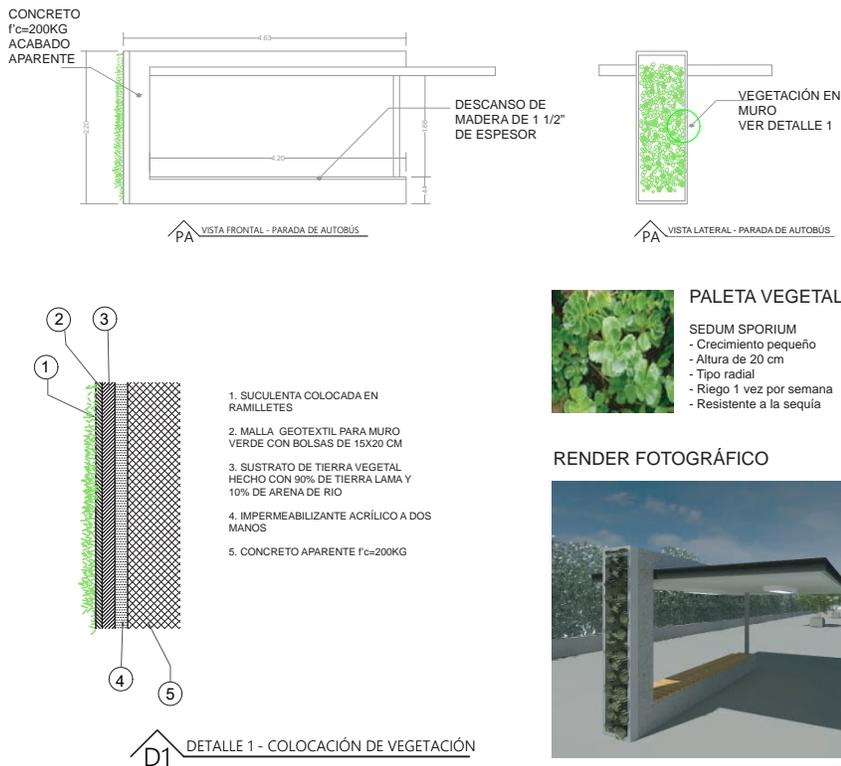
Propuesta de parada de autobús con muro verde. Fuente: EP.
